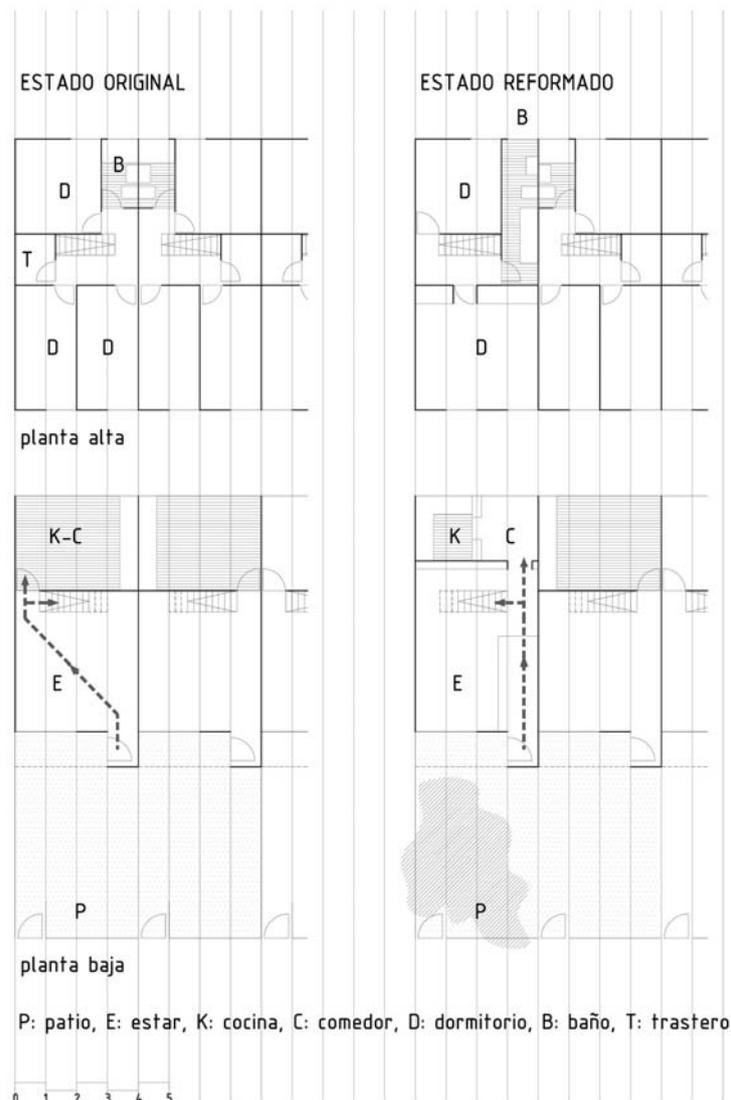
planta original y reformada de la vivienda de Luis Miquel
